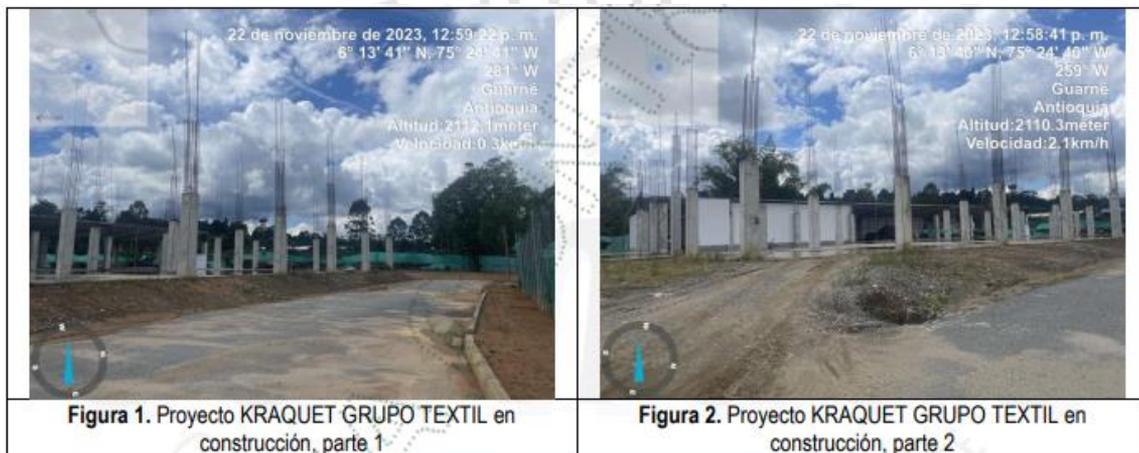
Proyecto KRAQUET GRUPO TEXTIL en construcción, parte 1
